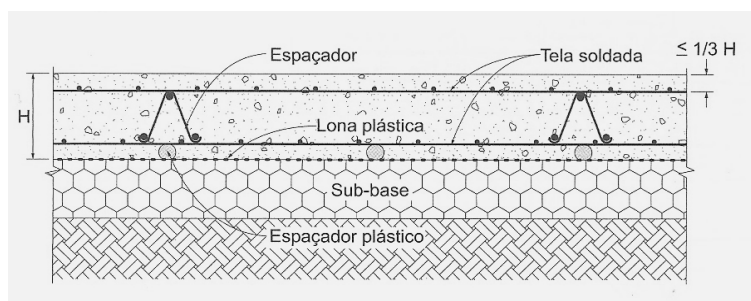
Seção tipo: Pavimento de concreto estruturalmente armado
